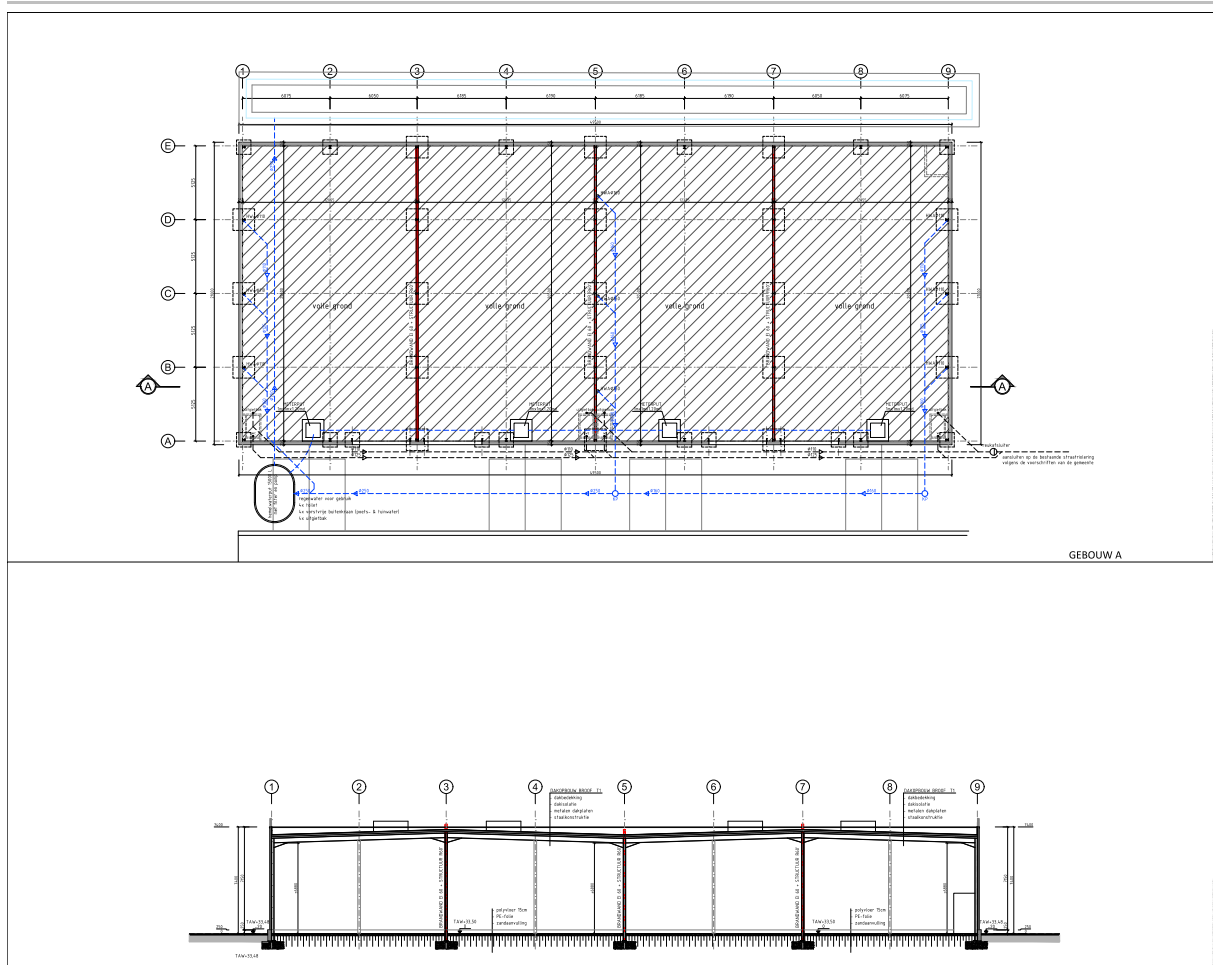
Funderingsplan en doorsnede gebouw A (als typevoorbeeld)².
